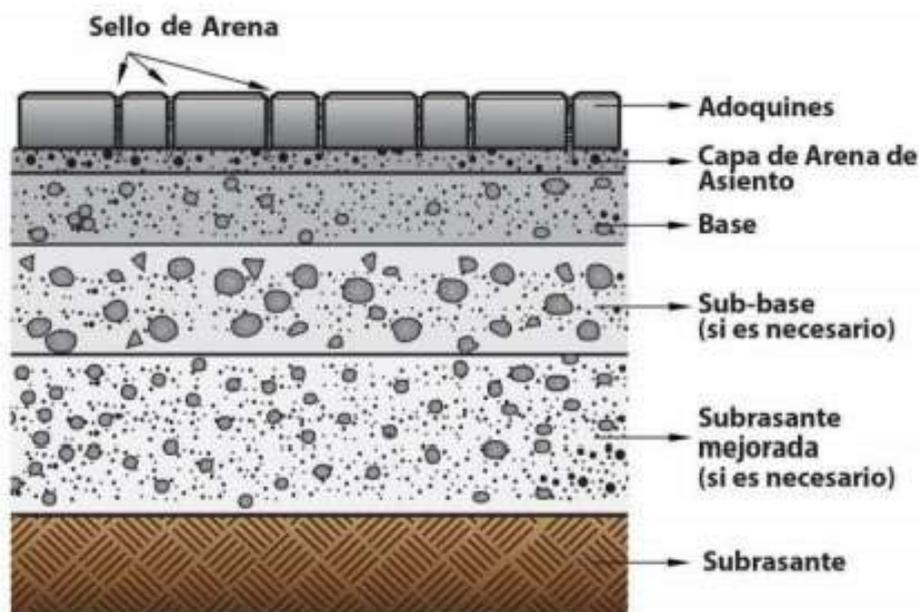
Estructura típica de un pavimento de adoquín. [33].
